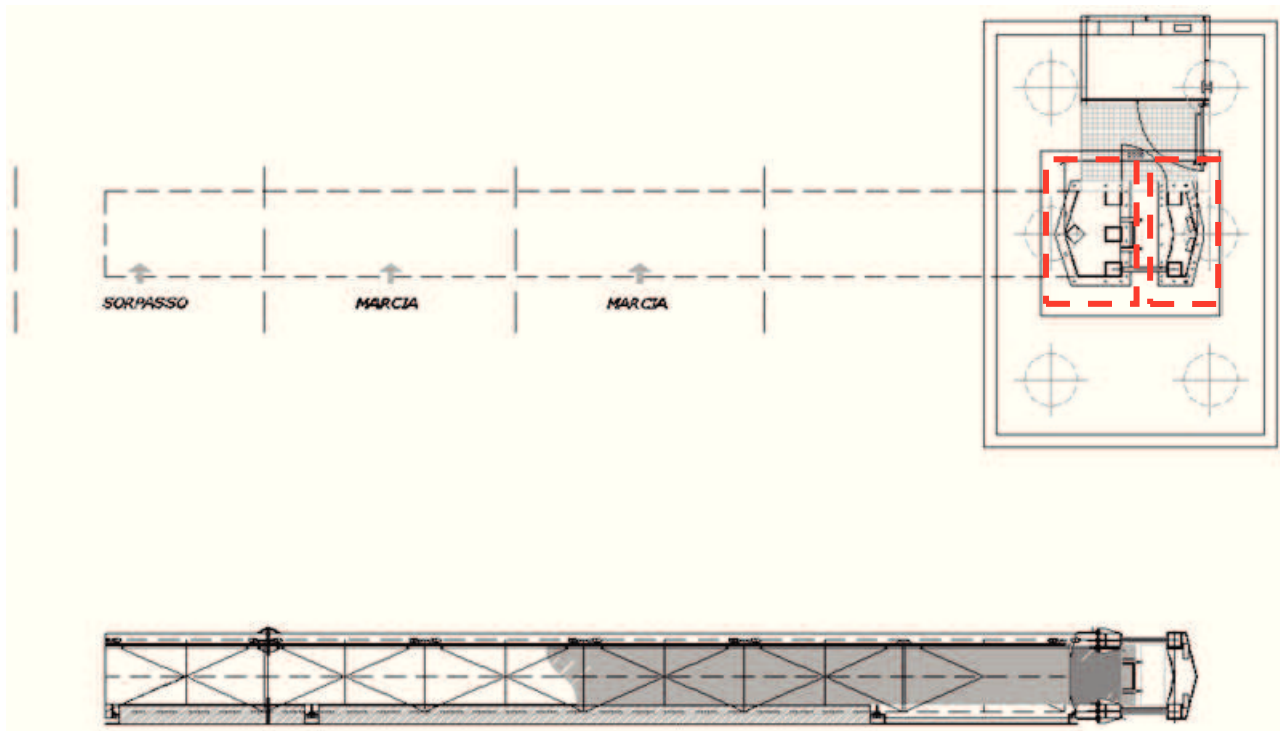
Vista in pianta e pianta del sistema di fondazione.
